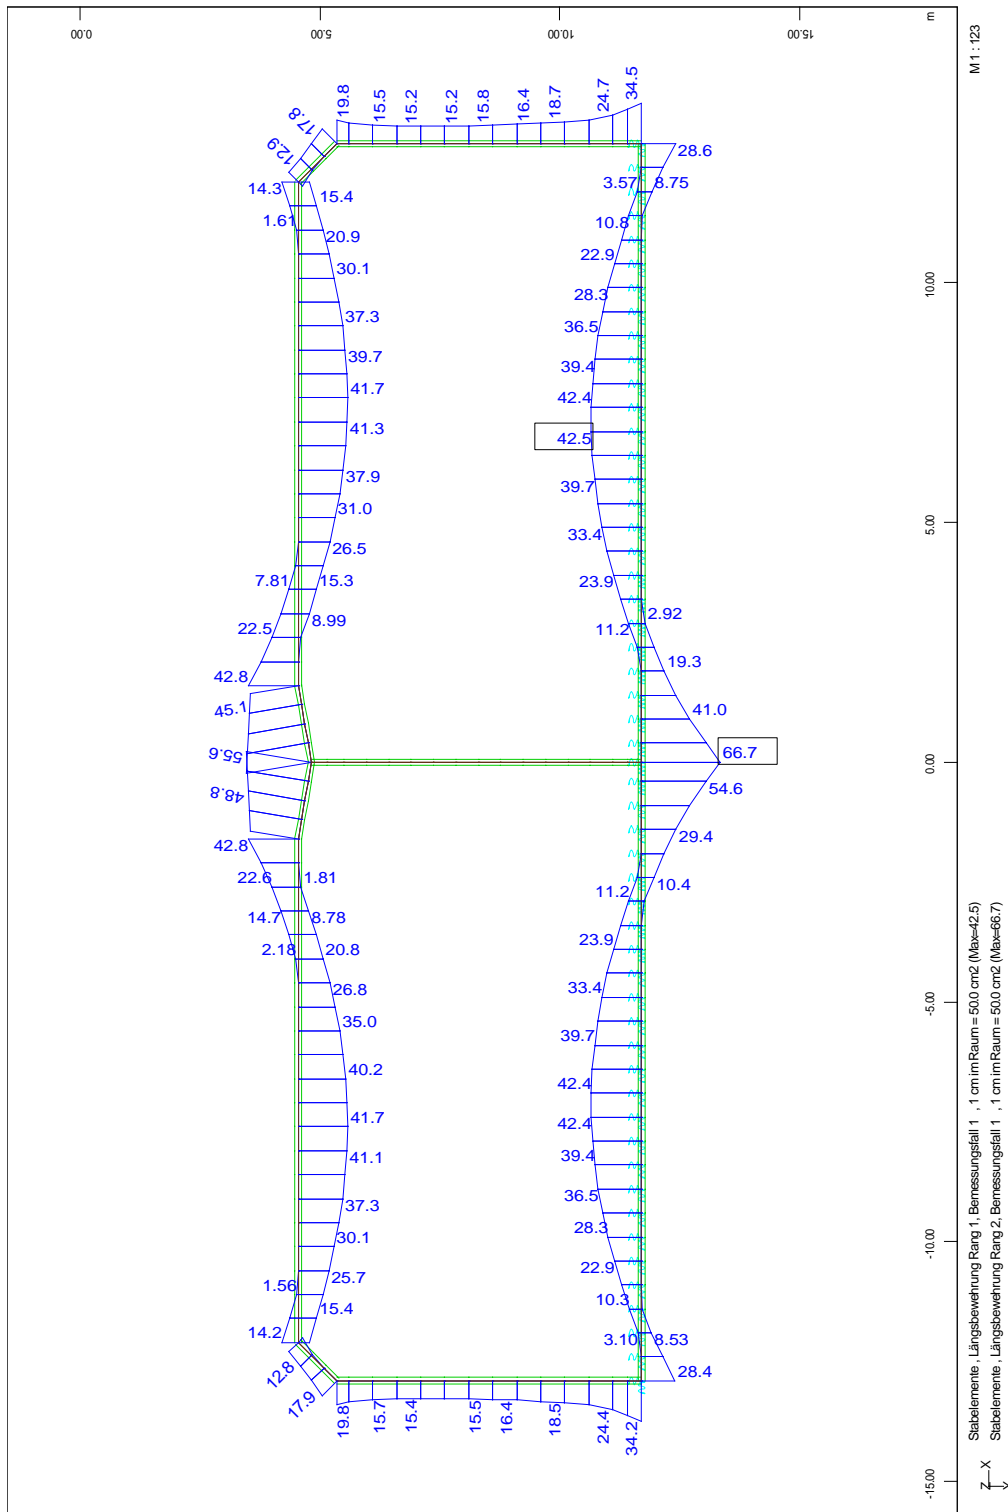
statisch erforderliche Biegebewehrung, ständige und vorübergehende Bemessungssituation
